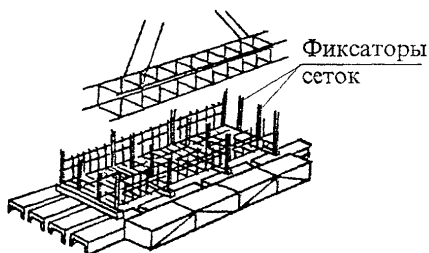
Кондуктор-шаблон для сборки каркасов
